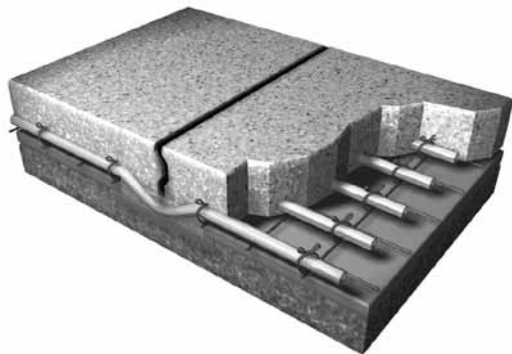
Tuyau immergé sous un joint de dilatation
